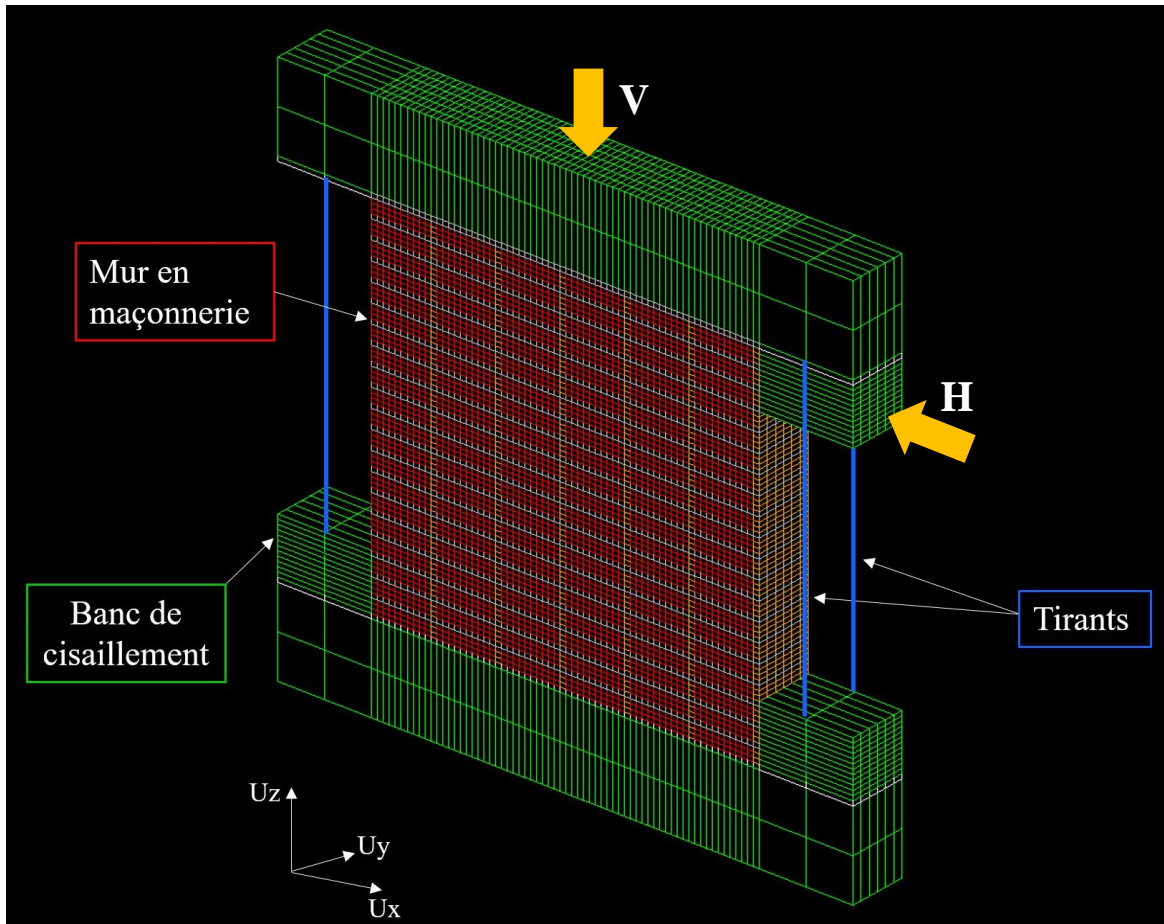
Maillage du mur et du banc de cisaillement sur Cast3m
